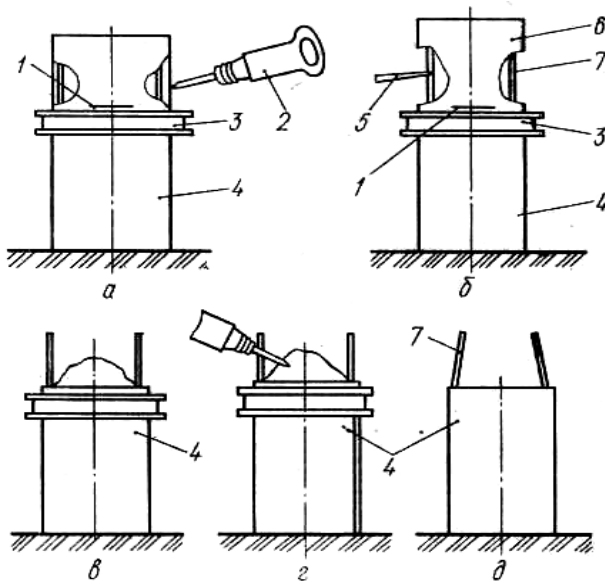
Схеми зрубки залізобетонних палей:
